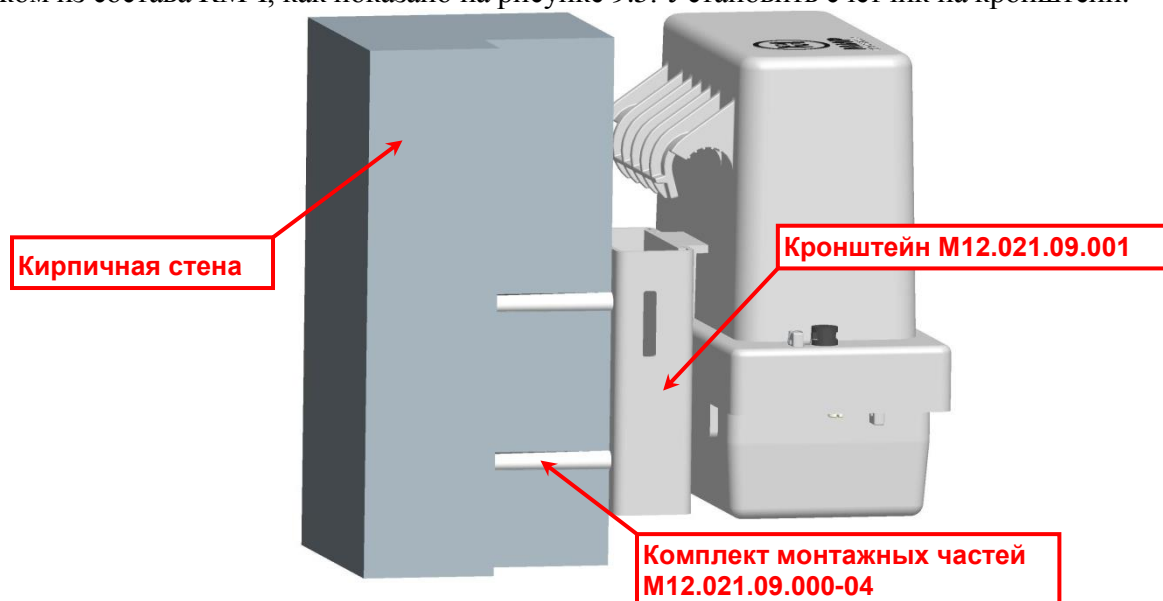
Установка счетчика на кирпичную или бетонную стену здания
